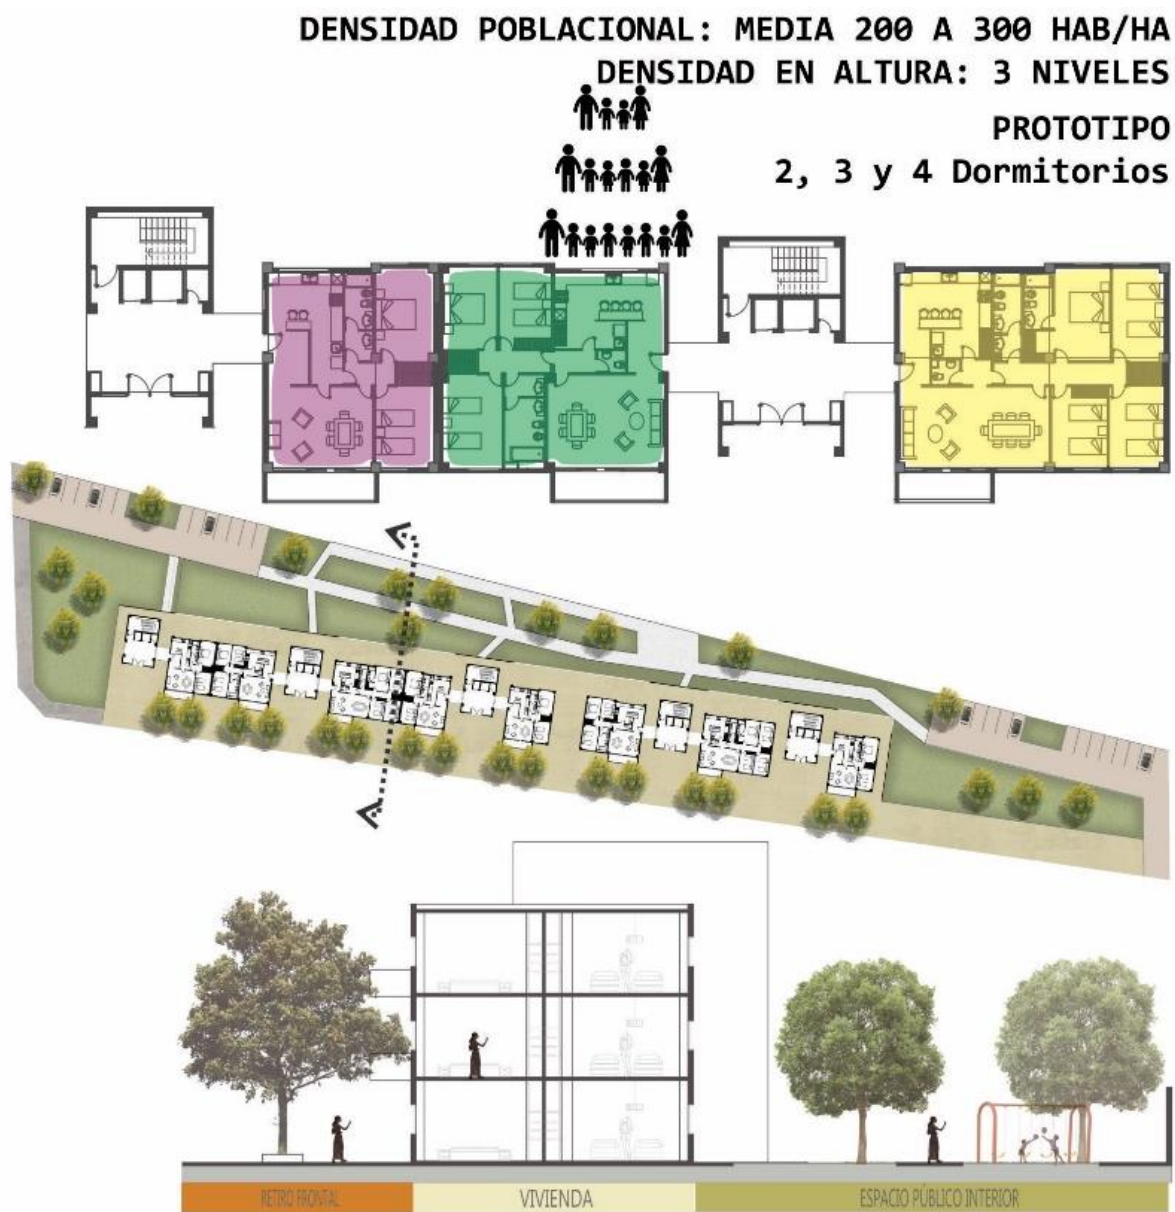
Prototipo de Vivienda en tira 1. Distribución en planta y corte.
